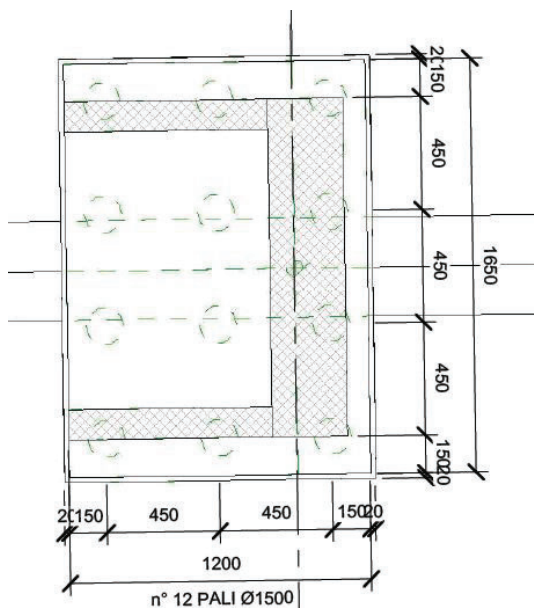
Pianta delle fondazioni delle pile e delle spalle
